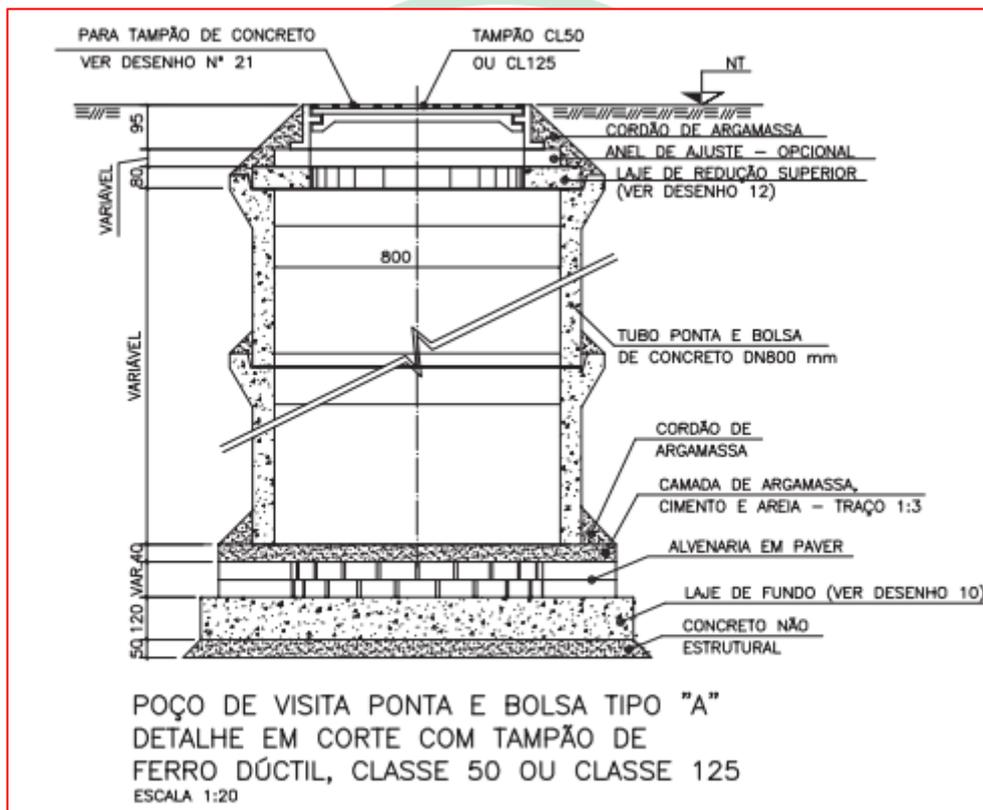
Execução de PV - tipo A - conforme SANEPAR - corte - Fonte: SANEPAR
